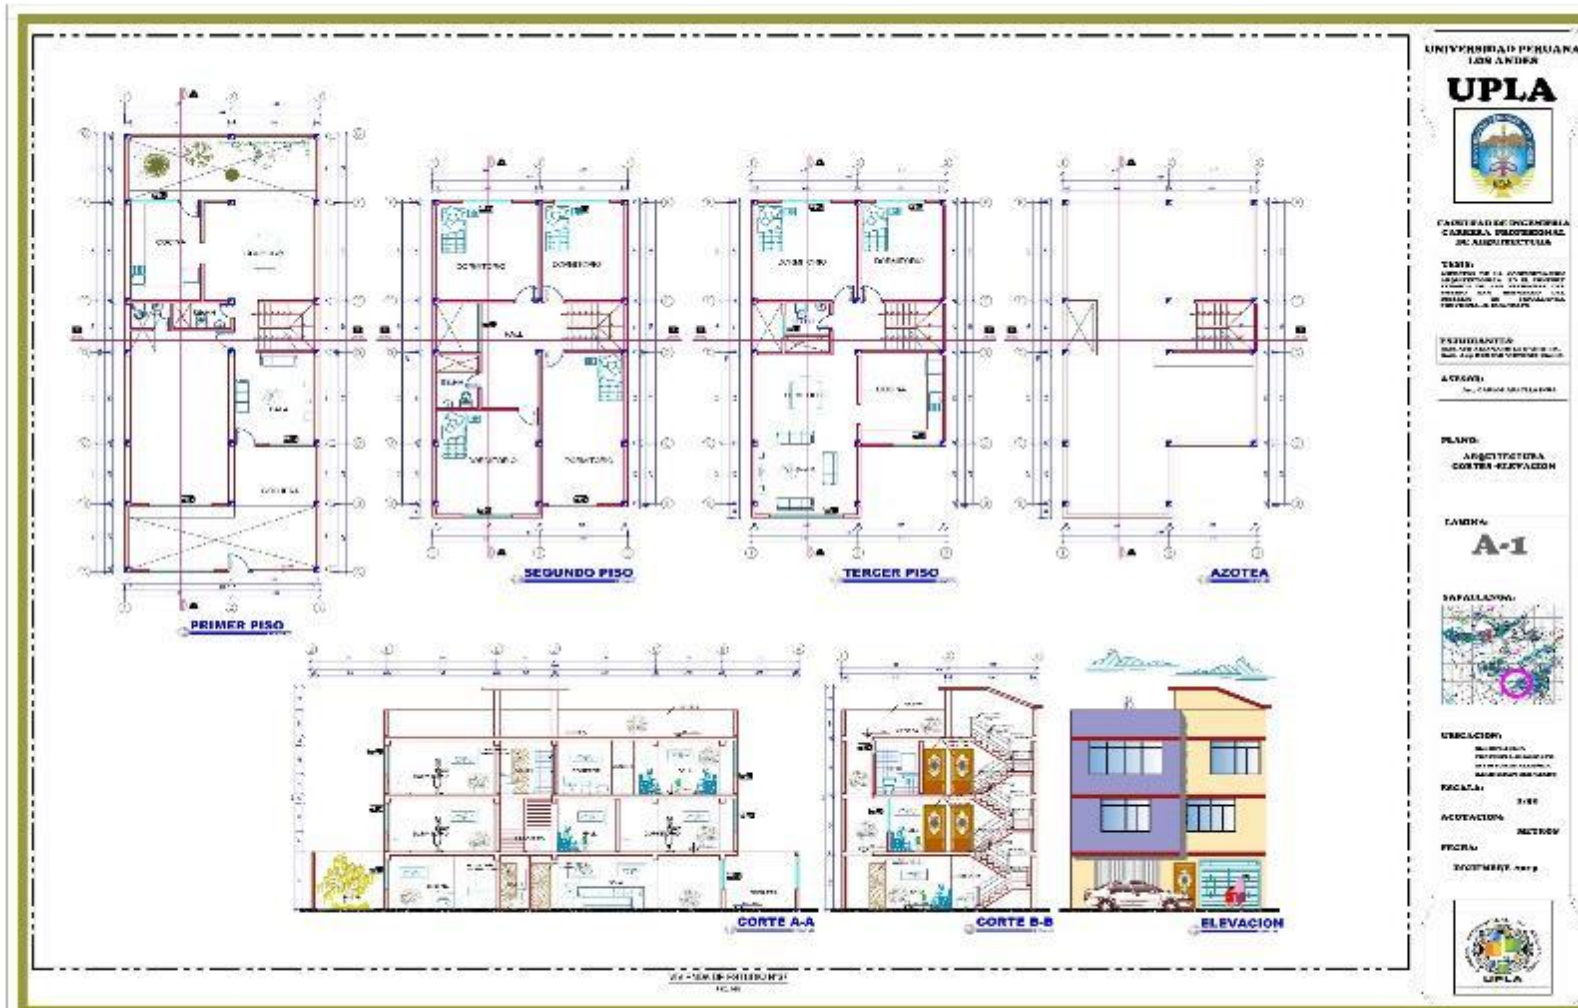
Plano de plantas, cortes y detalles de materiales de la vivienda N°37 del Barrio San Bernardo del distrito de Sapallanga.
